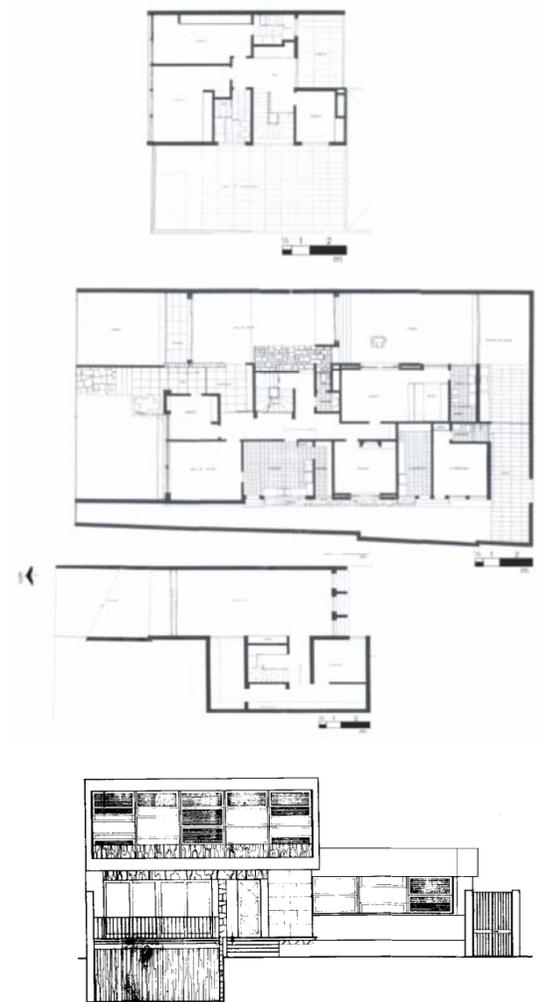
Casa João Wilson Vaz. Plantas baixas subsolo, térreo, superior e Fachada.
